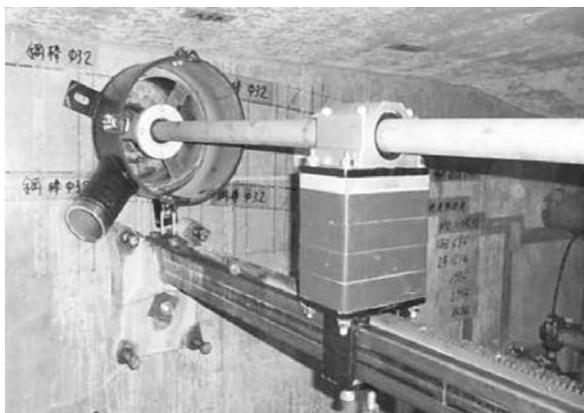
柱頭部横桁の施工状況 (建設時資料より)
